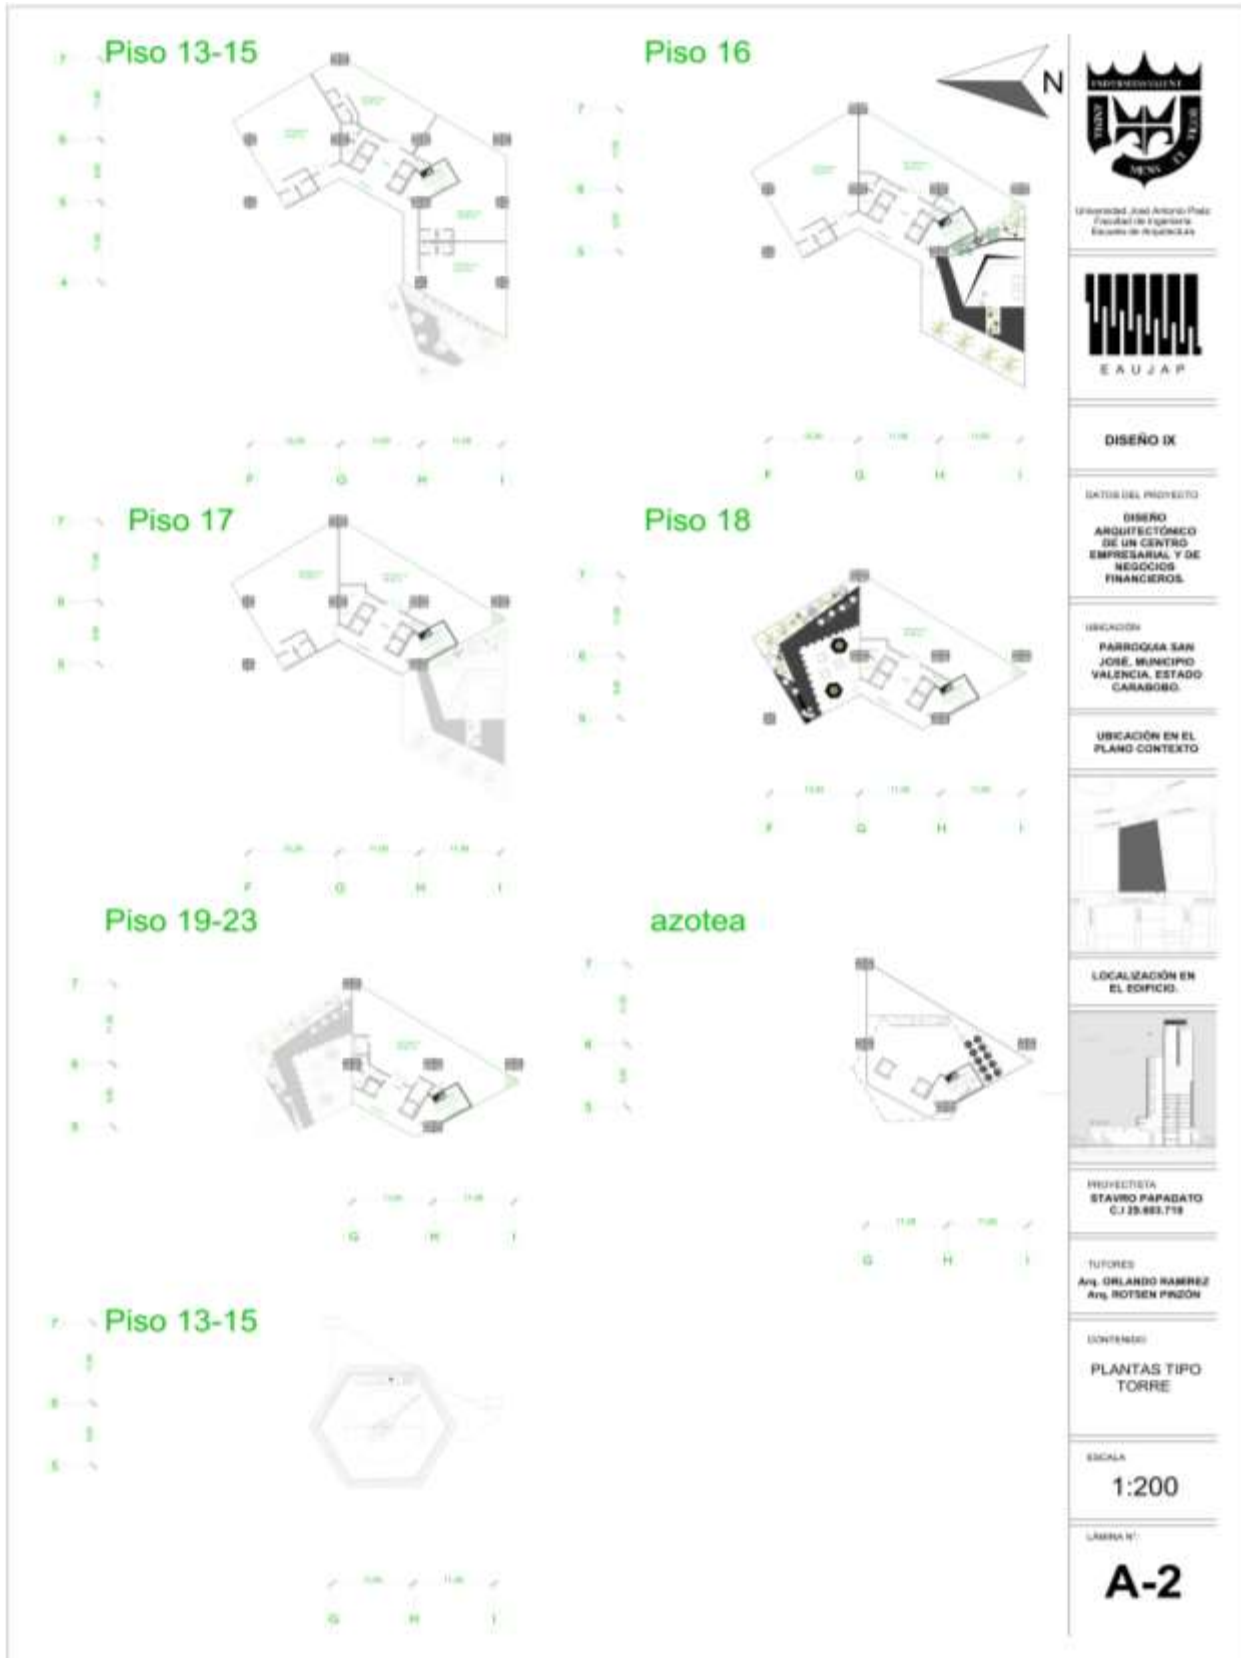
A-2 Planta Tipo Torre. (Piso 13 al 15/Piso 16/Piso 17/Piso 18/Piso 19 al 23/Azotea) Fuente: El Autor (2023)
